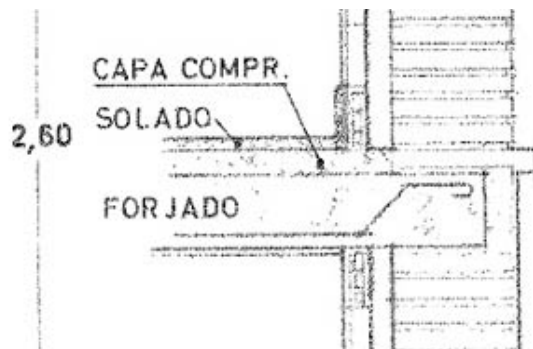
Detalle tipo de forjado. Fuente: Archivo de la Villa de Madrid.
